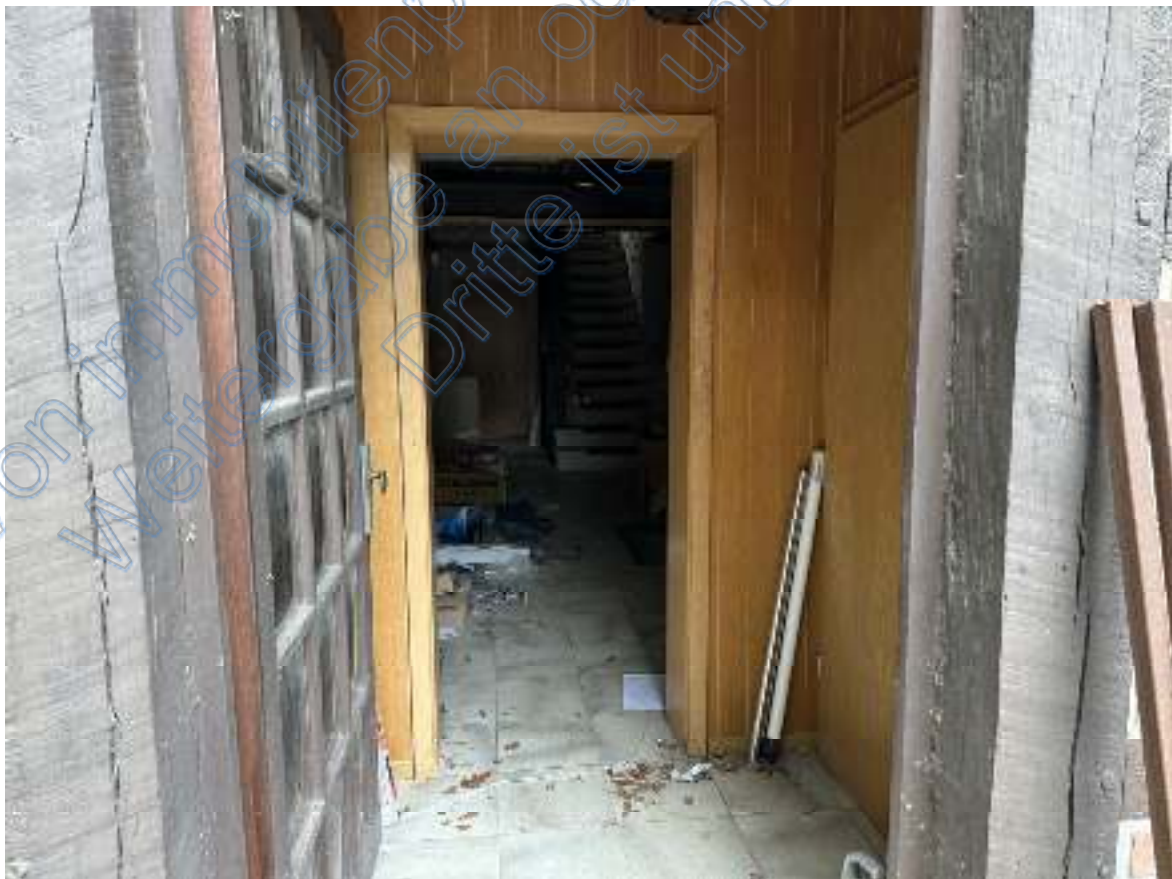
Ausschnitt – Windfang Richtung *offener Tür* zur Diele
